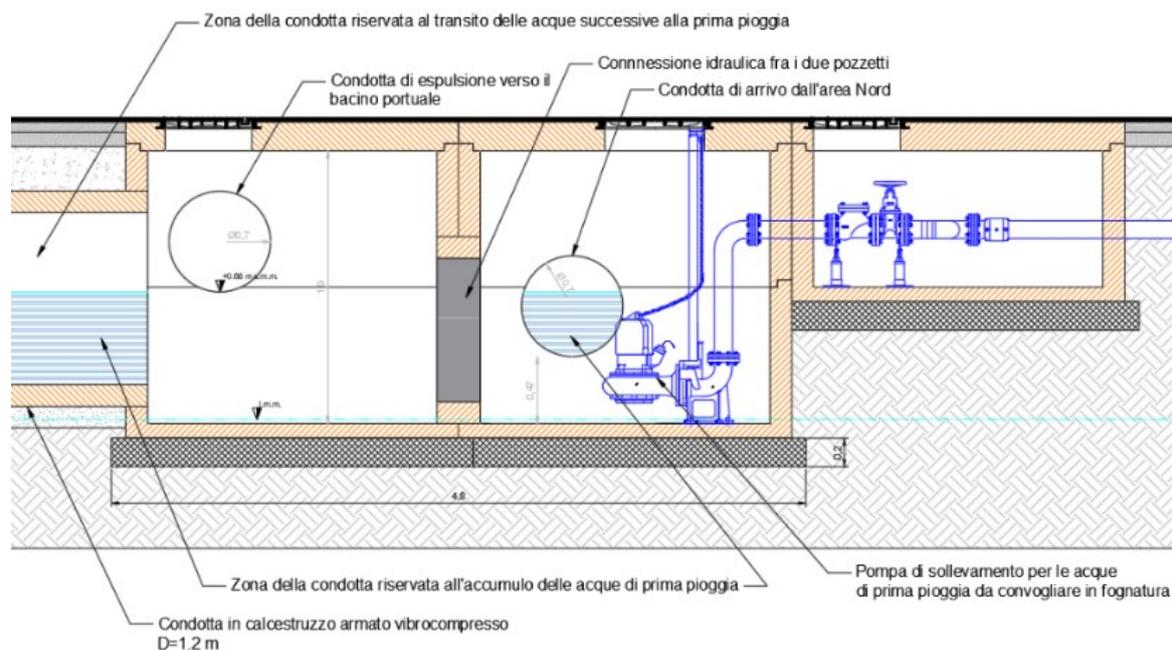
Sezione trasversale del pozzetto di smistamento.
